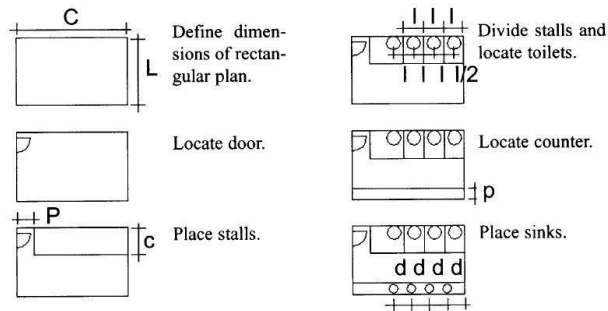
Passo a passo da construção de um layout Fonte: CELANI, Gabriela, 2002
